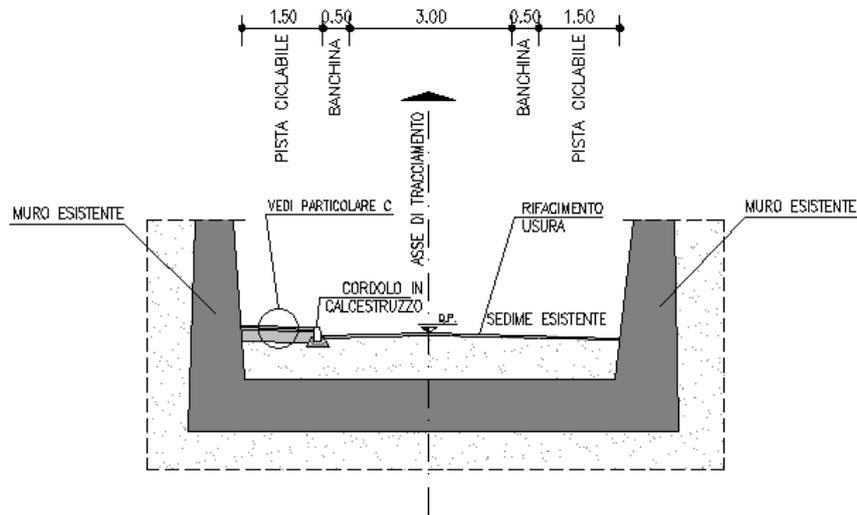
Sezione tipo di progetto via Piave nel tratto in sottopasso e fra muri
